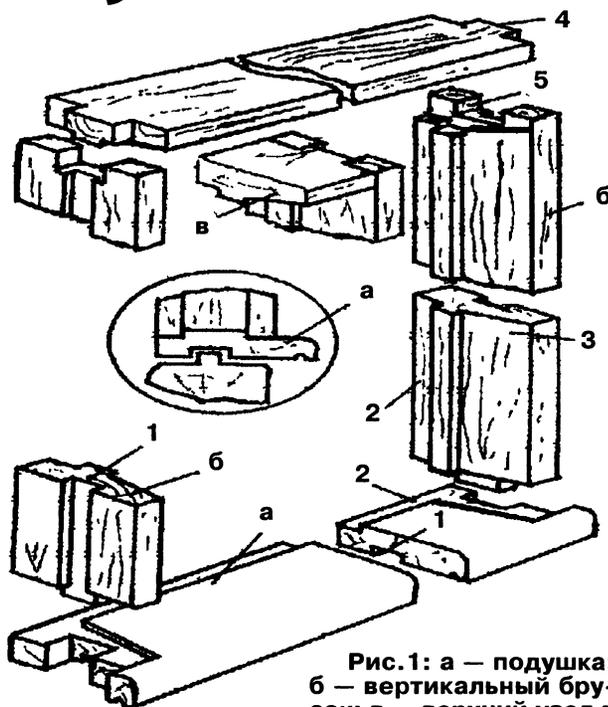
а — подушка; б — вертикальный брусочек; в — верхний узел в сборе; 1 — паз; 2 — четверть; 3 — откос; 4 — шип; 5 — проушина;
